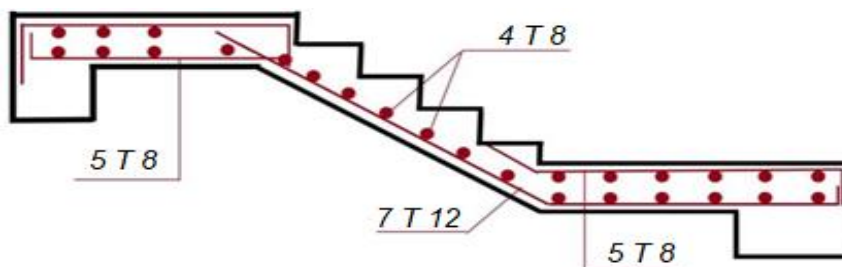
Schéma du ferrailage de la volée 2 de l'escalier.
